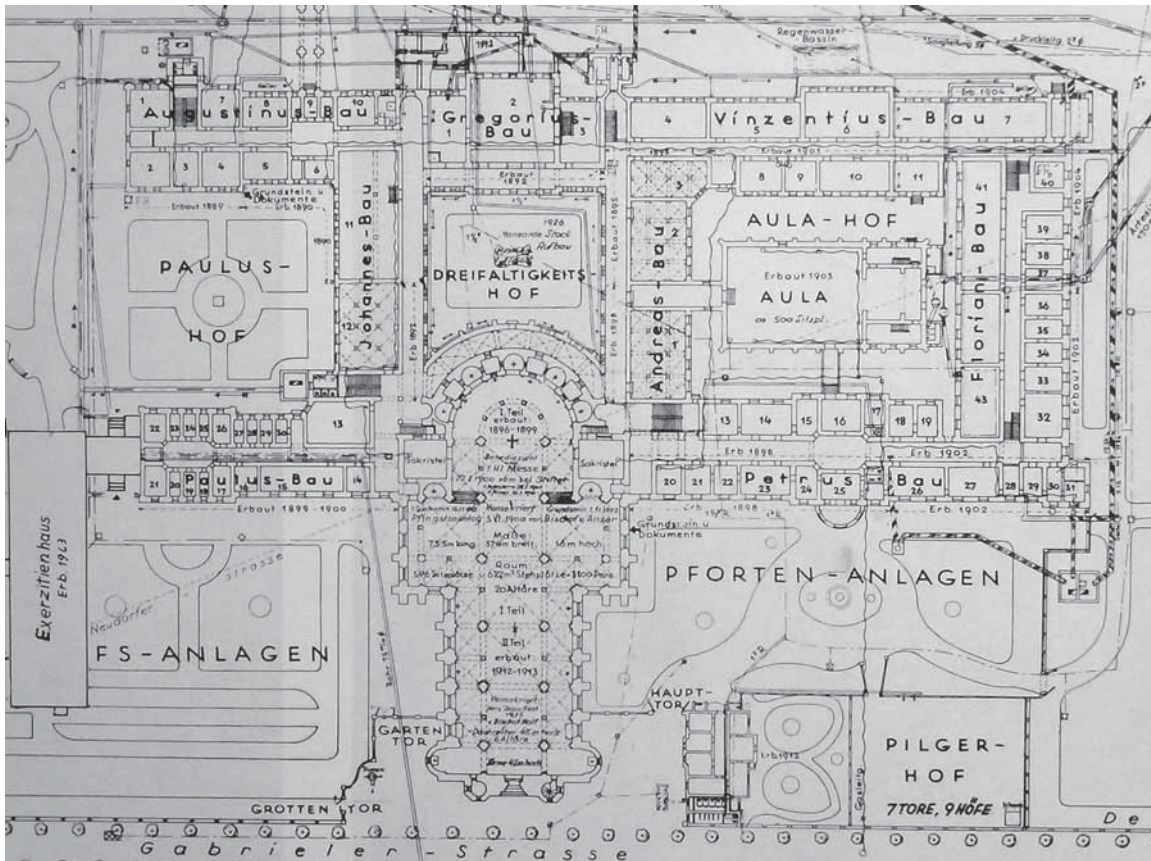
Gesamtanlageplan Missionshaus St. Gabriel
